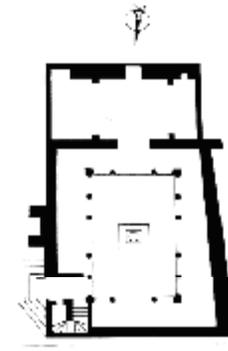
مسقط أفقي للدور الأرضي للمدرسة الجديدة بمكناس
